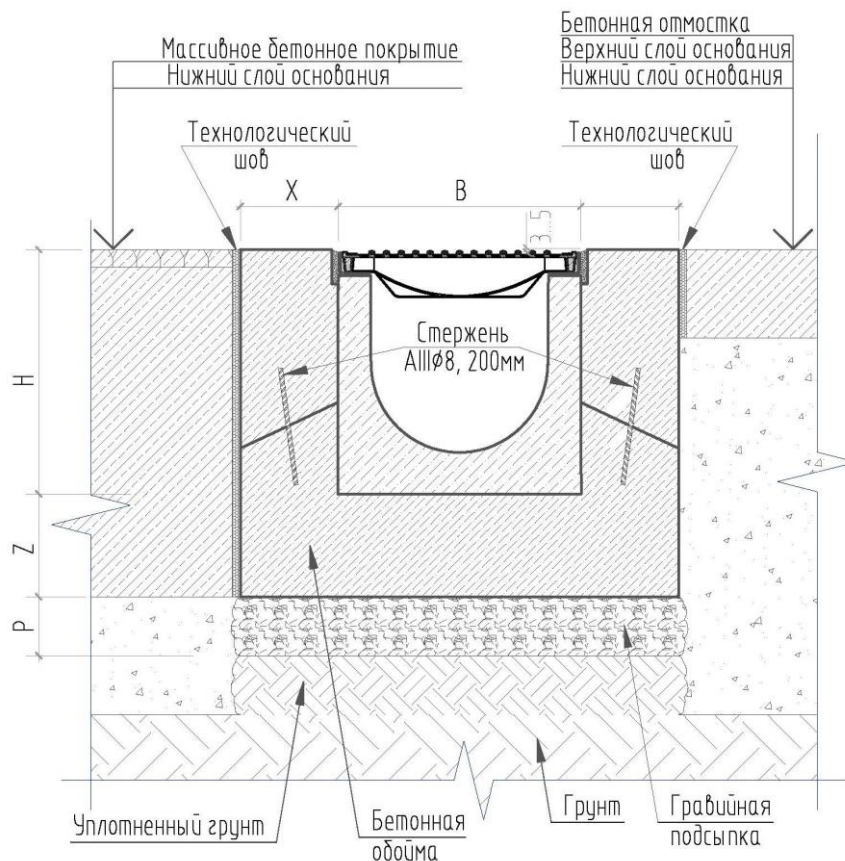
Монтаж бетонных лотков с бетонным покрытием для высоких классов нагрузки от D400 до E600.
